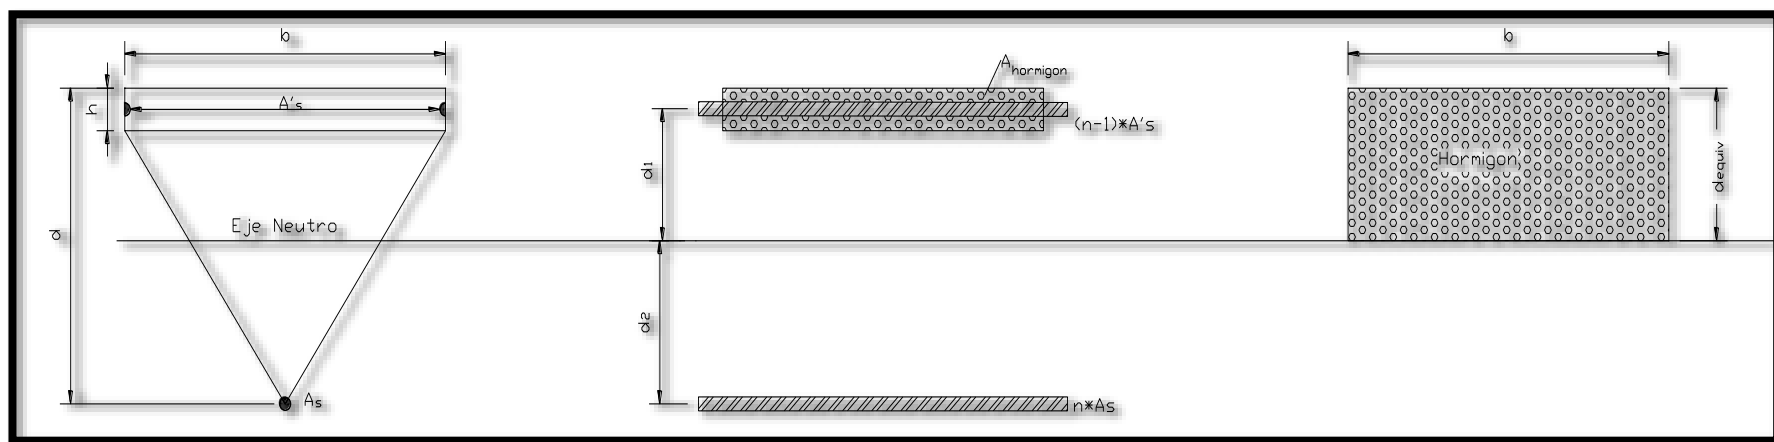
a) Tridilosa de ancho b, b) sección transformada, c) losa de H° con inercia equivalente
